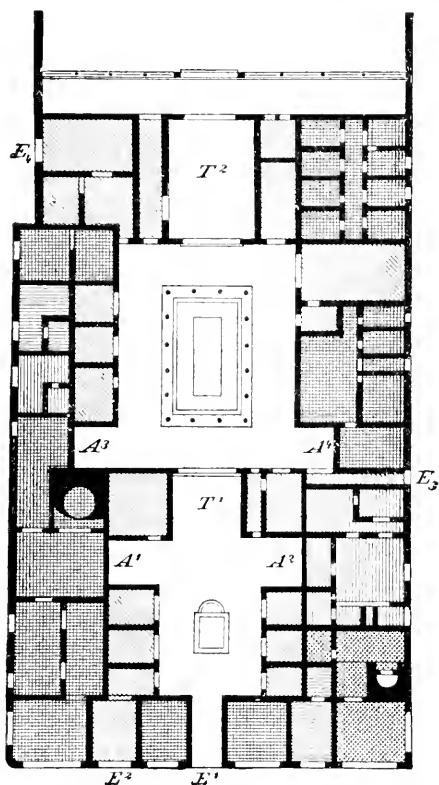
Grundriss des Hauses des Pansa zu Pompeji.
